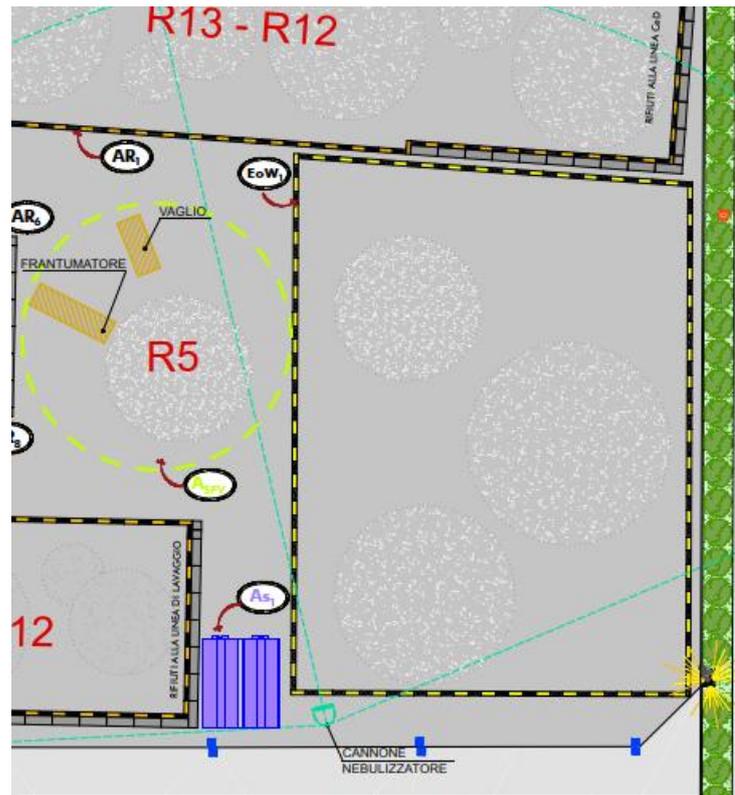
Stralcio planimetria con aree dedicate allo stoccaggio degli End of Waste
